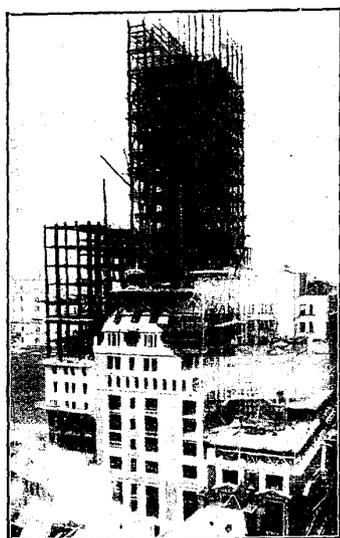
Singer Building avec les contreventements à droite de l'ossature.
